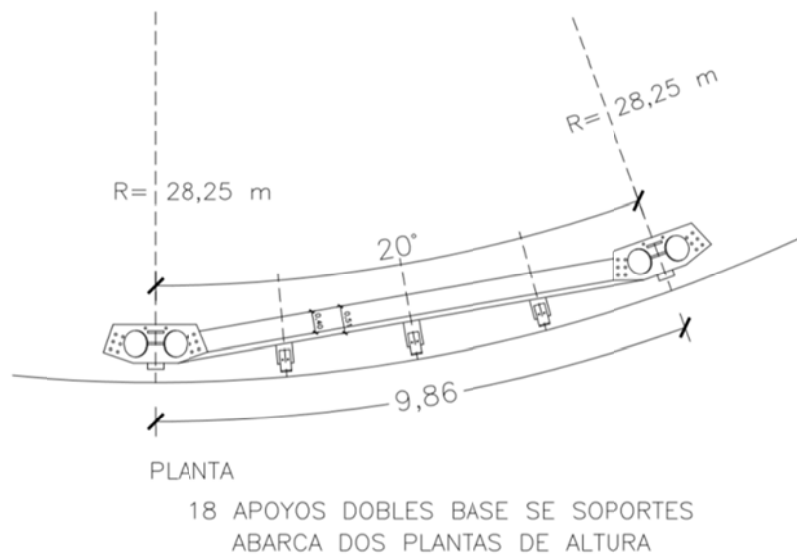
Detalle de planta de las cabezas de soportes del esquema anterior. Fuente: Elaboración propia. © AutoCAD.
